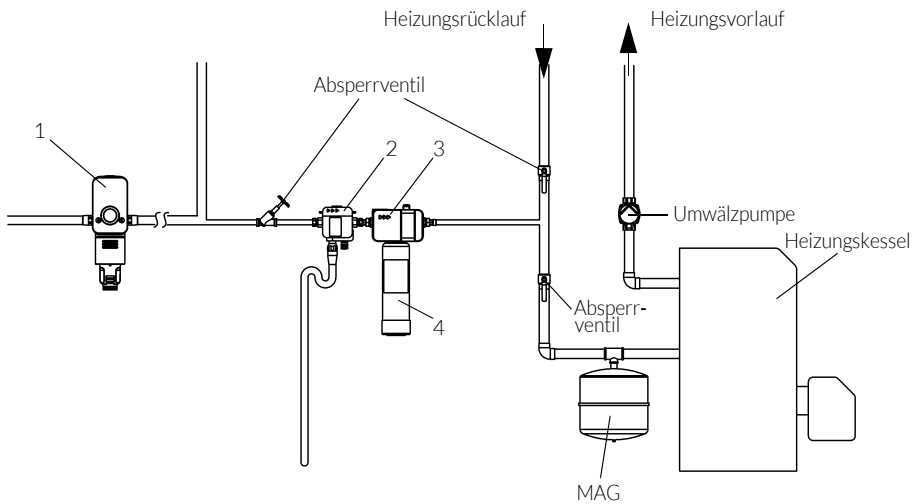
CLEAR FILL Heizungsbefüllung mit fest eingebauter Füllstation
